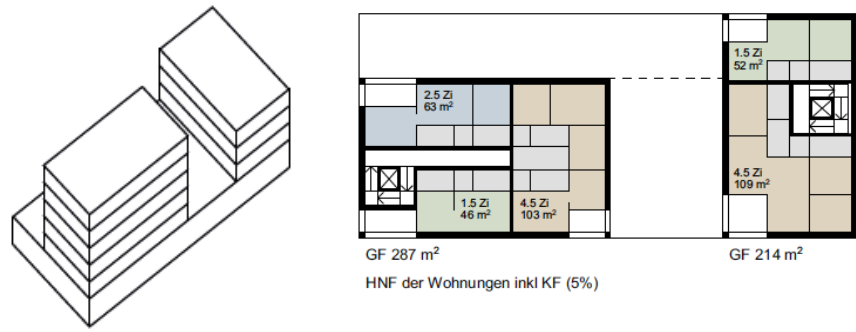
3D-Ansicht neuer Baukörper sowie Regelgrundriss Obergeschoss.
